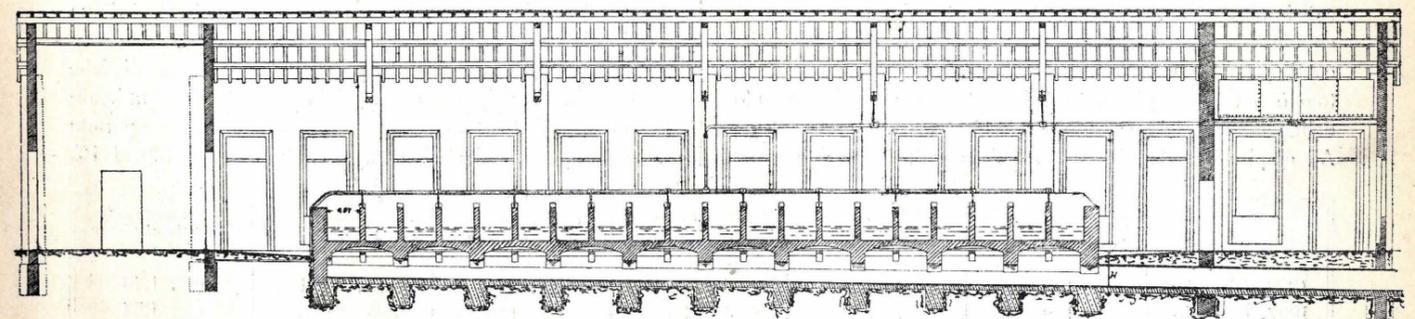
Sezione longitudinale del fabbricato (Scala 1:200).
